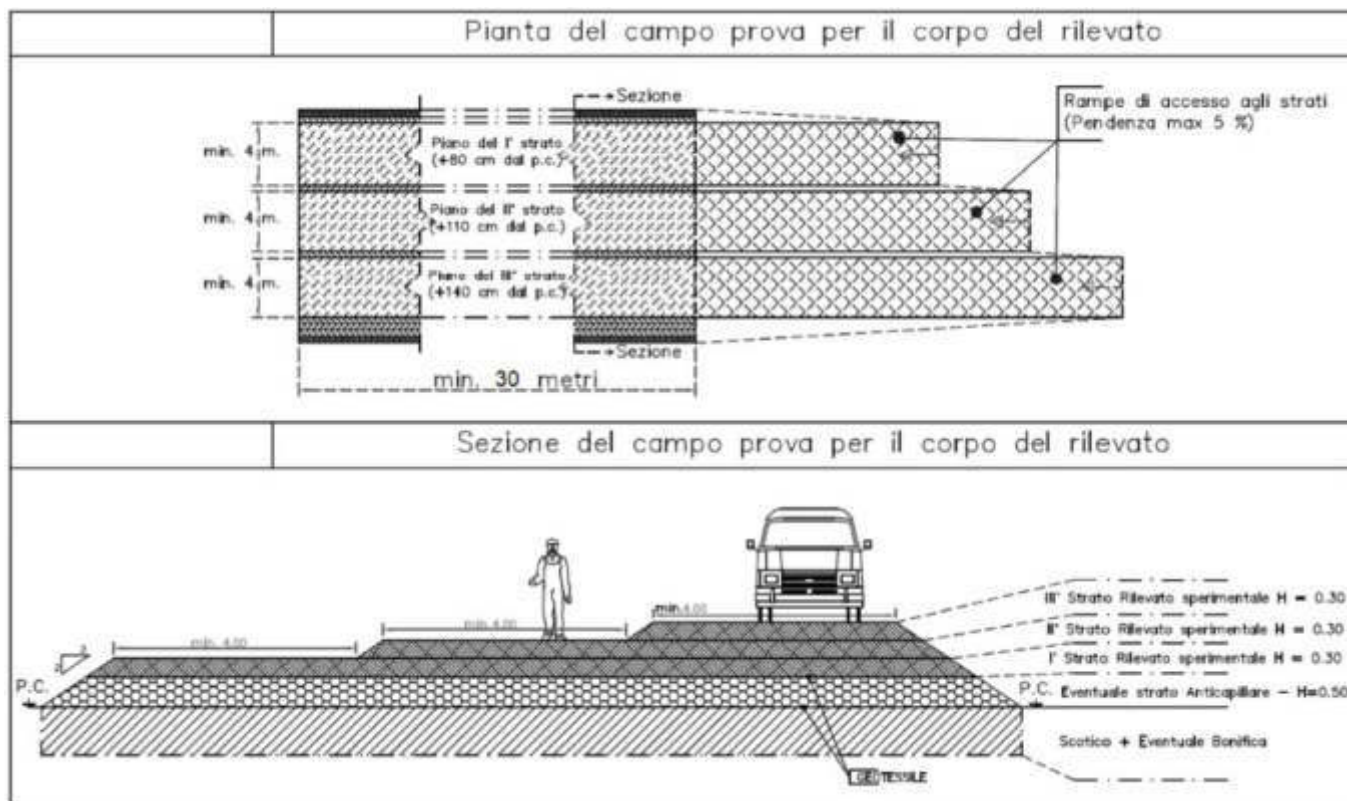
Pianta e sezione del campo prova per il corpo del rilevato
